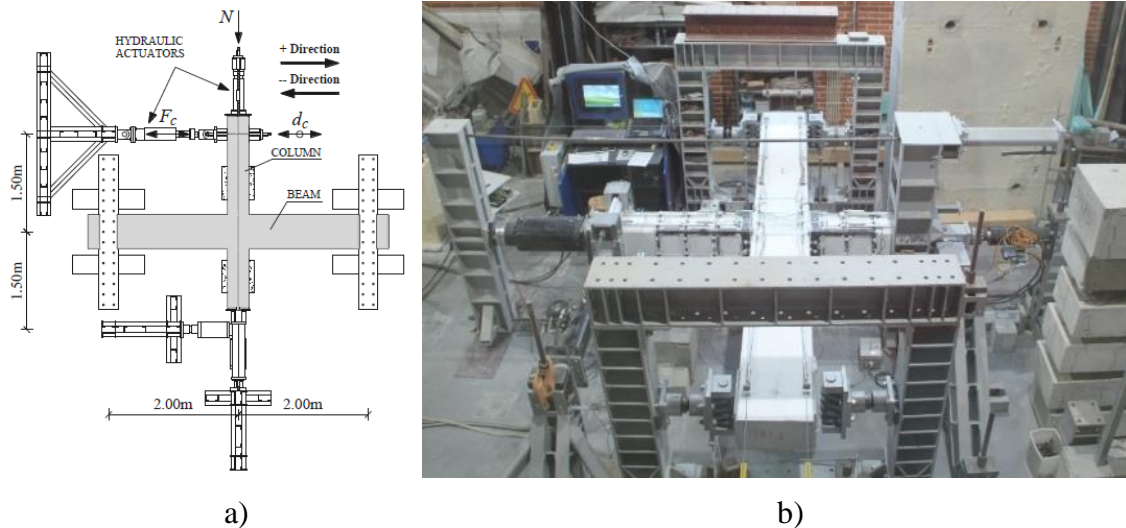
Plataforma de ensaio: a) em planta, adaptado Melo (2014); b) vista geral
